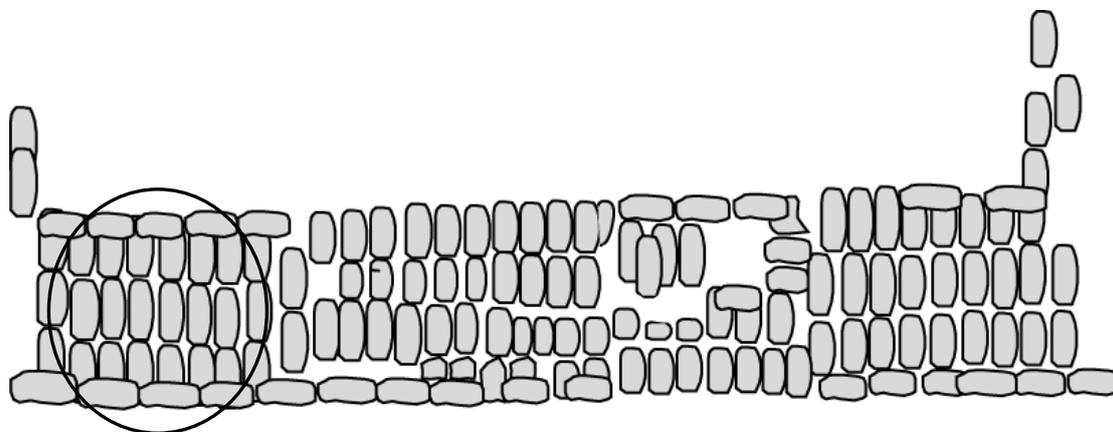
Dibujo muro UE208. Detalle aparejo (2014).
